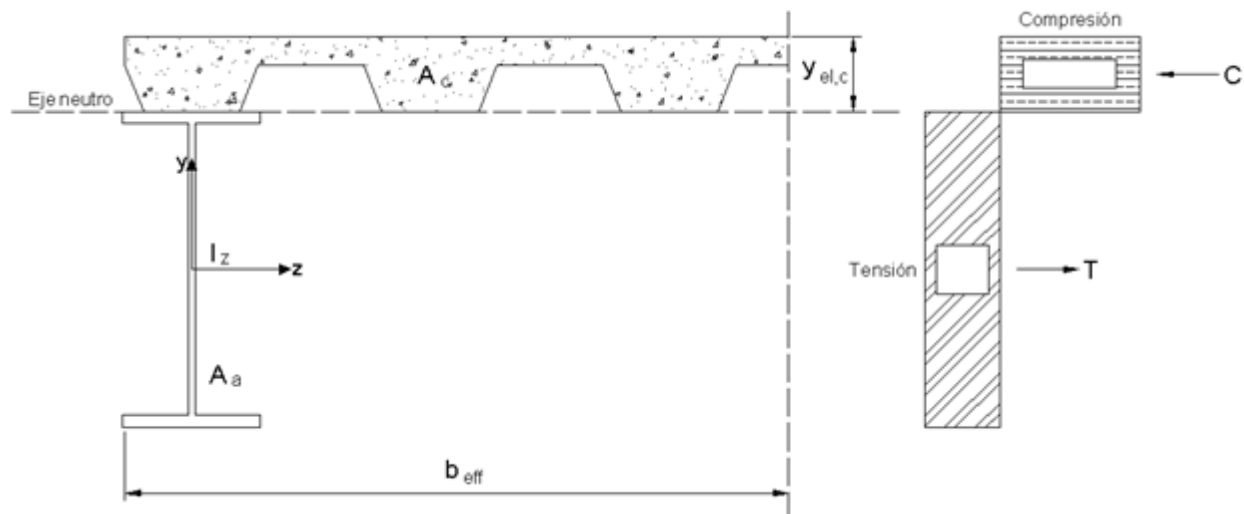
Modelo de sección transversal compuesta para cada viga longitudinal
